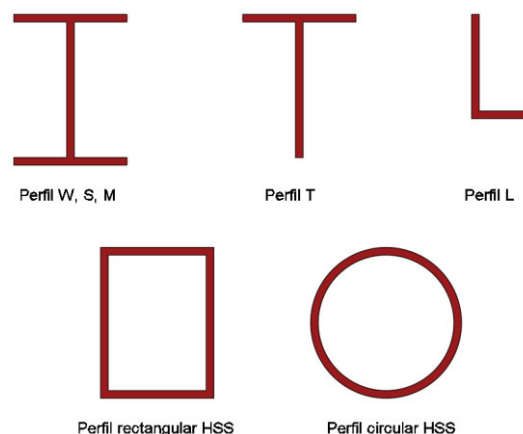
Tipos de perfiles estructural empleados en la construcción.
